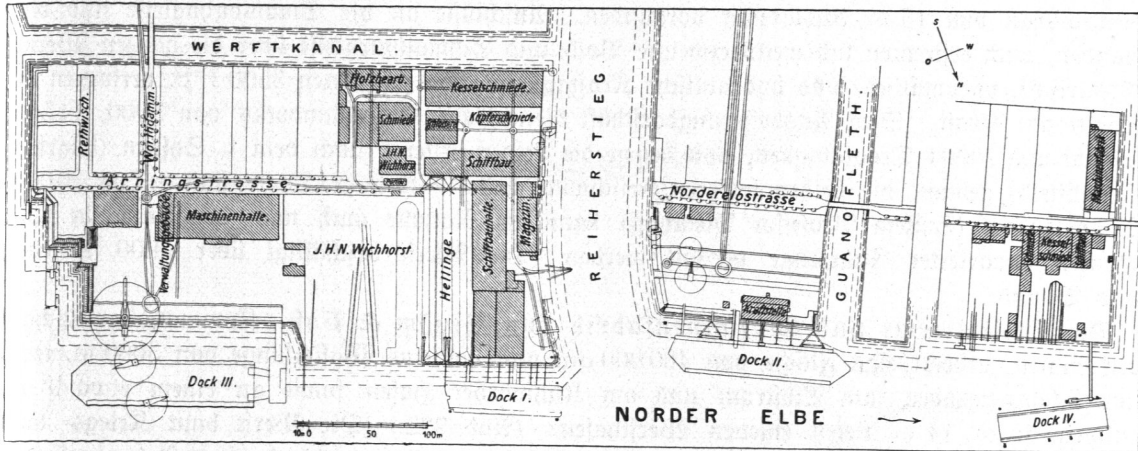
Reiherstieg-Schiffswerfte und Maschinenfabrik, Lageplan.
